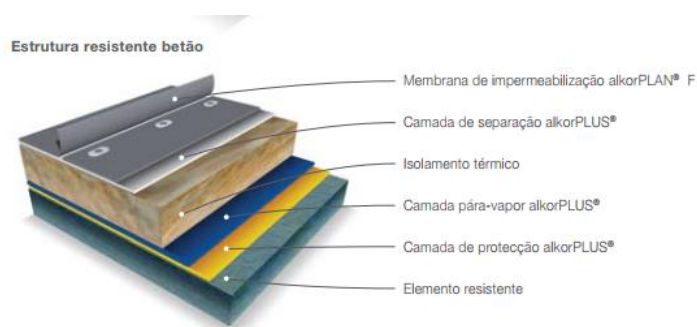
Exemplo de aplicação do sistema de impermeabilização da cobertura com estrutura resistente de betão [Fonte: Renolit Waterproofing]
